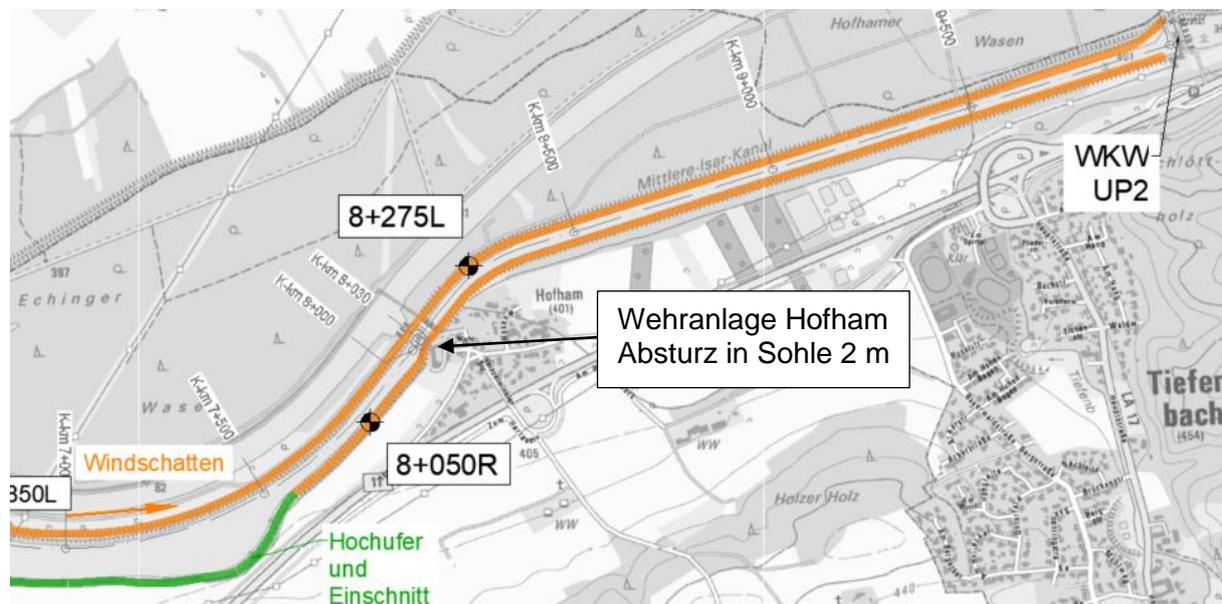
Lageplan in Abschnitt 3 des Untersuchungsgebiets
